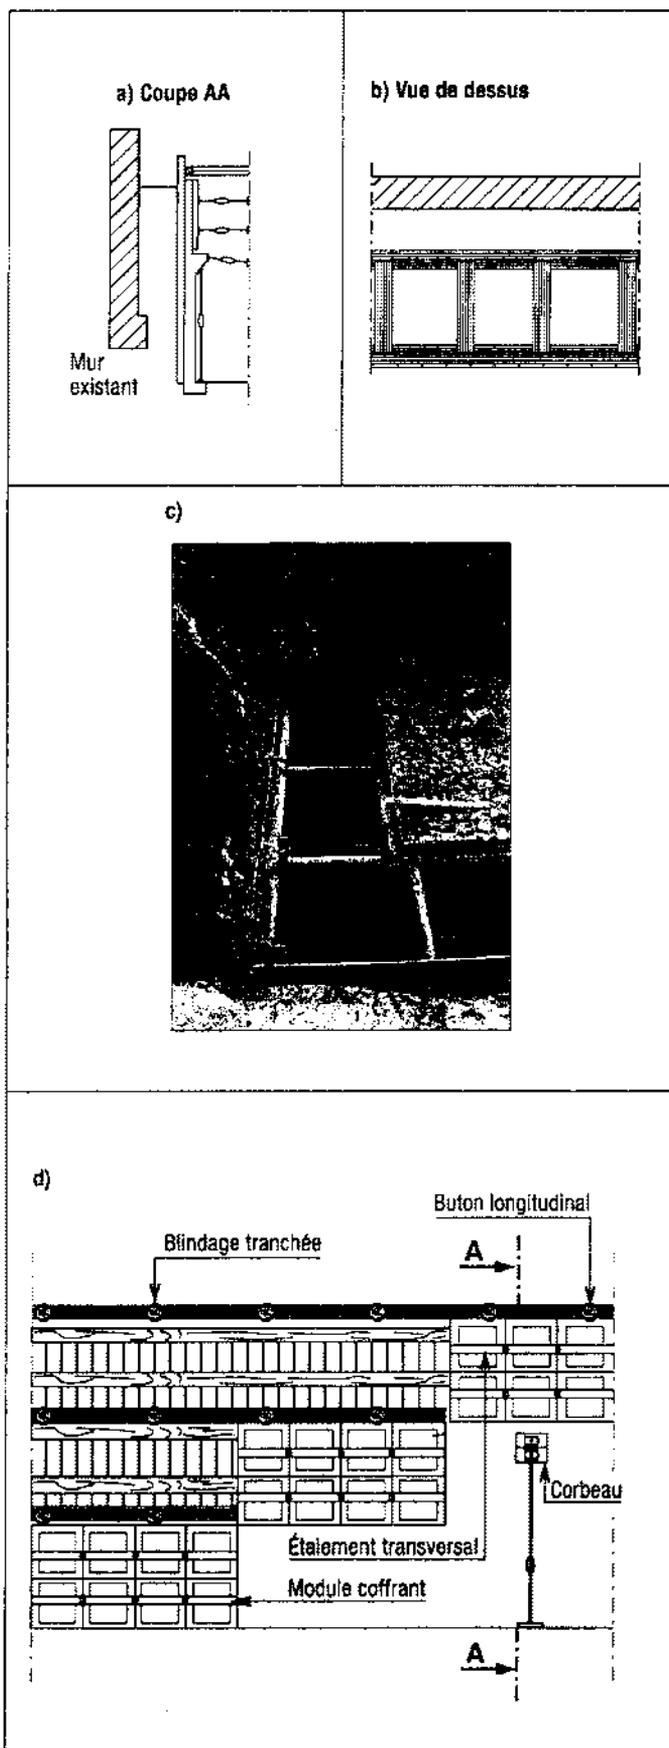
Réalisation de la paroi de l'avancement : coffrage et phasage.
